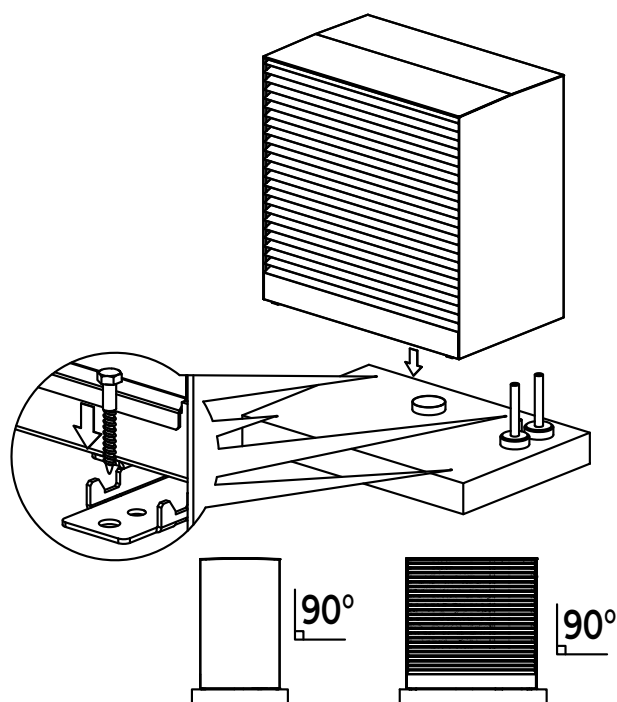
AirCalor-K -35 – Installation sur la fondation et nivellement.
